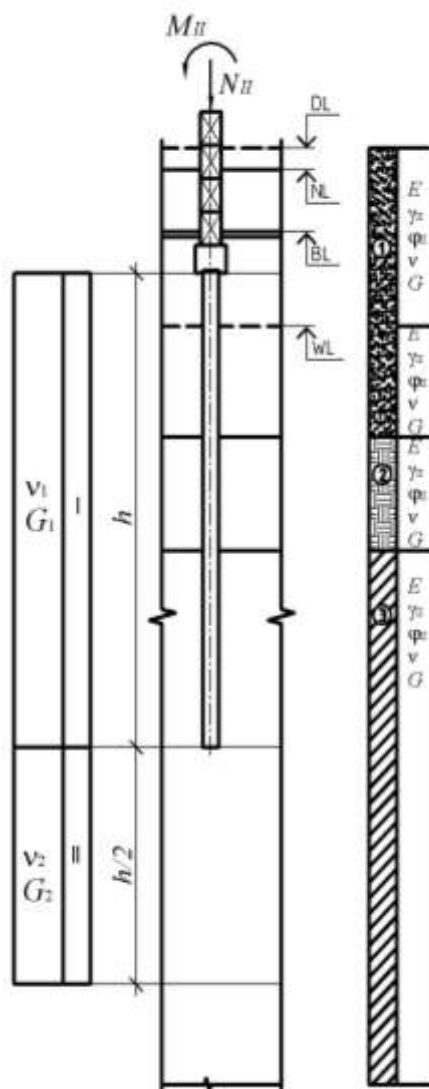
Схема к расчету свайного фундамента по деформациям (при низком ростверке)
